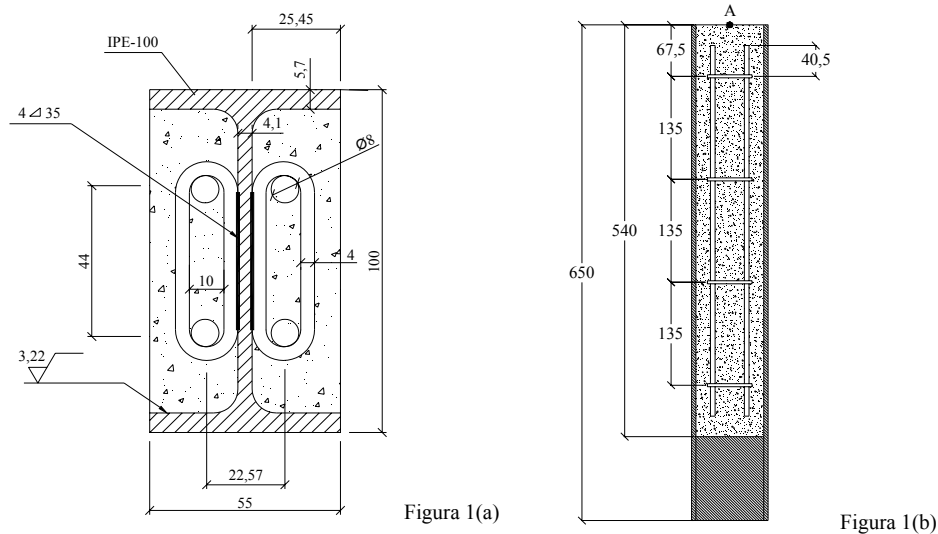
Probeta con la que se estudia el contacto entre hormigón y perfil metálico (cotas en [mm]). (a) Sección de la viga parcialmente embebida. (b) Diseño longitudinal de la probeta.
